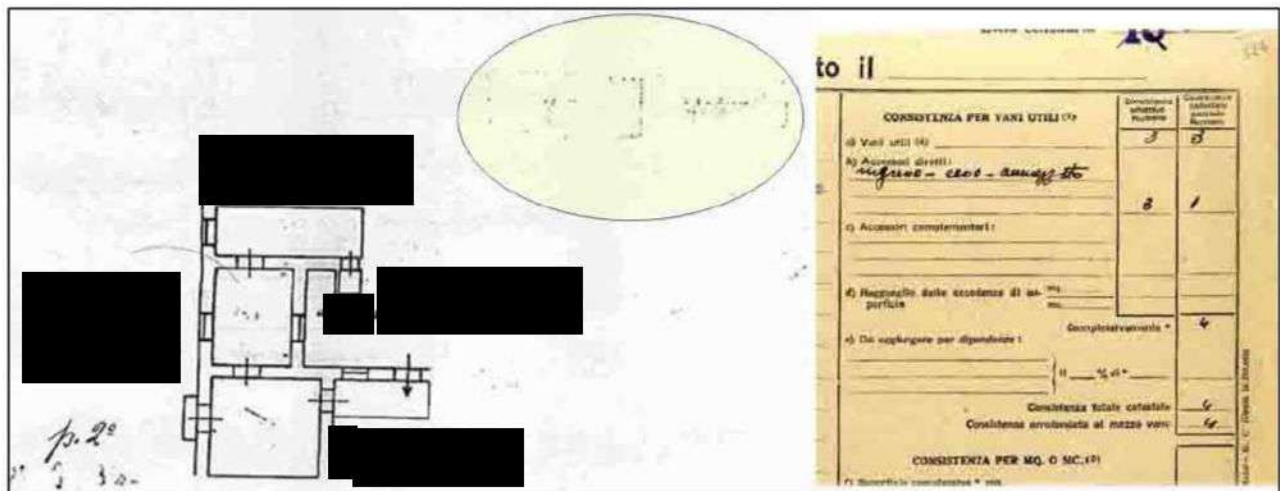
Planimetria catastale d'impianto. Nell'ovale in giallo è visibile un disegno sbiadito che potrebbe rappresentare il soppalco. Affianco stralcio del Mod 5 di accertamento e classamento. Tra gli accessori dell'U.I. viene indicato anche l'ammezzato/soppalco.
